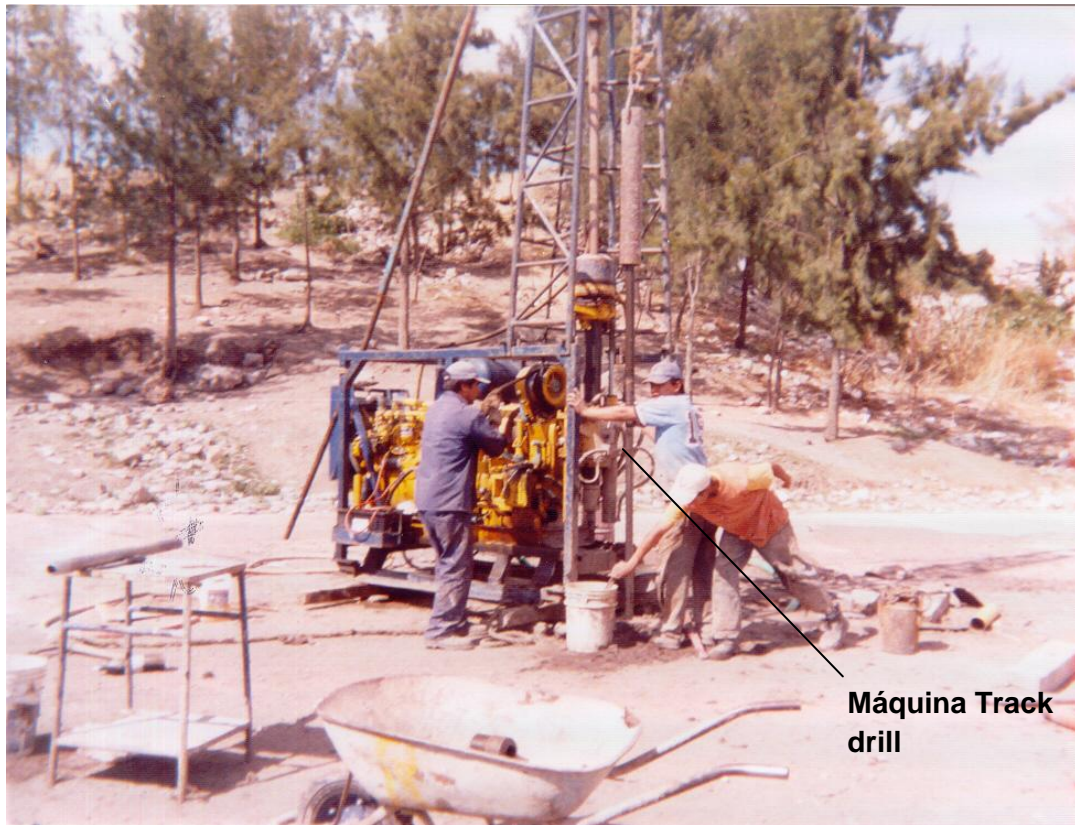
Preparación de máquina track drill para pruebas de penetración estándar
